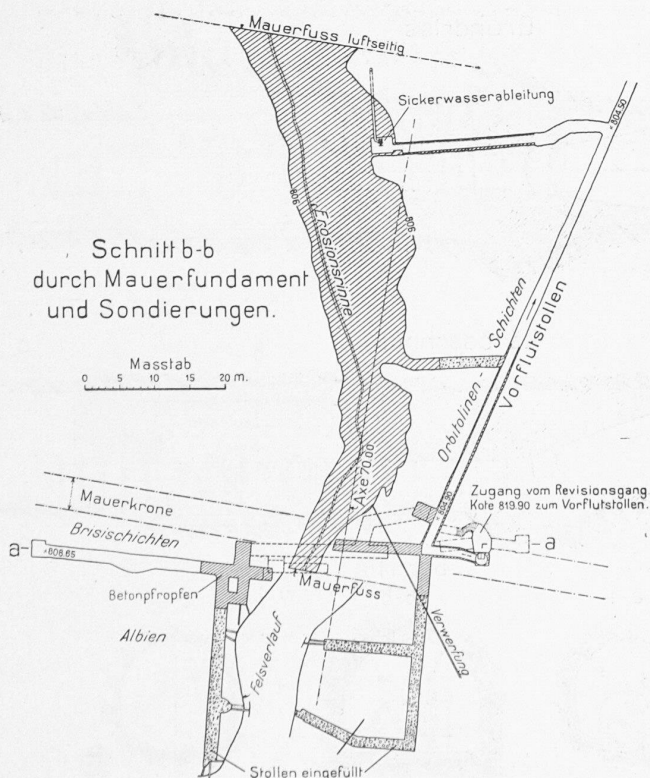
und 13. Sondierung der Staumauer-Baustelle im Schräh, 1 : 1000.
